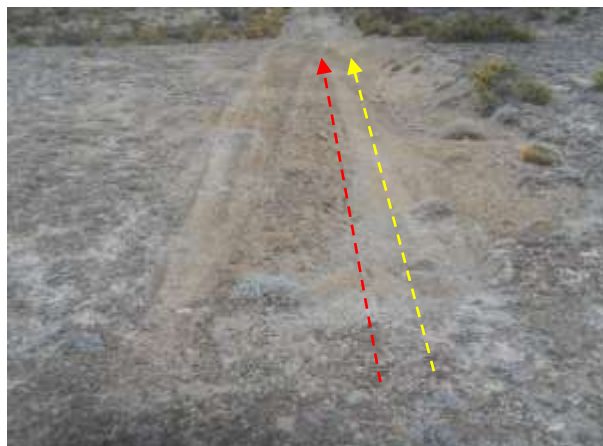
Se observa emplazamiento de ductos por picada con signos de erosión. Foto en dirección Sur.
